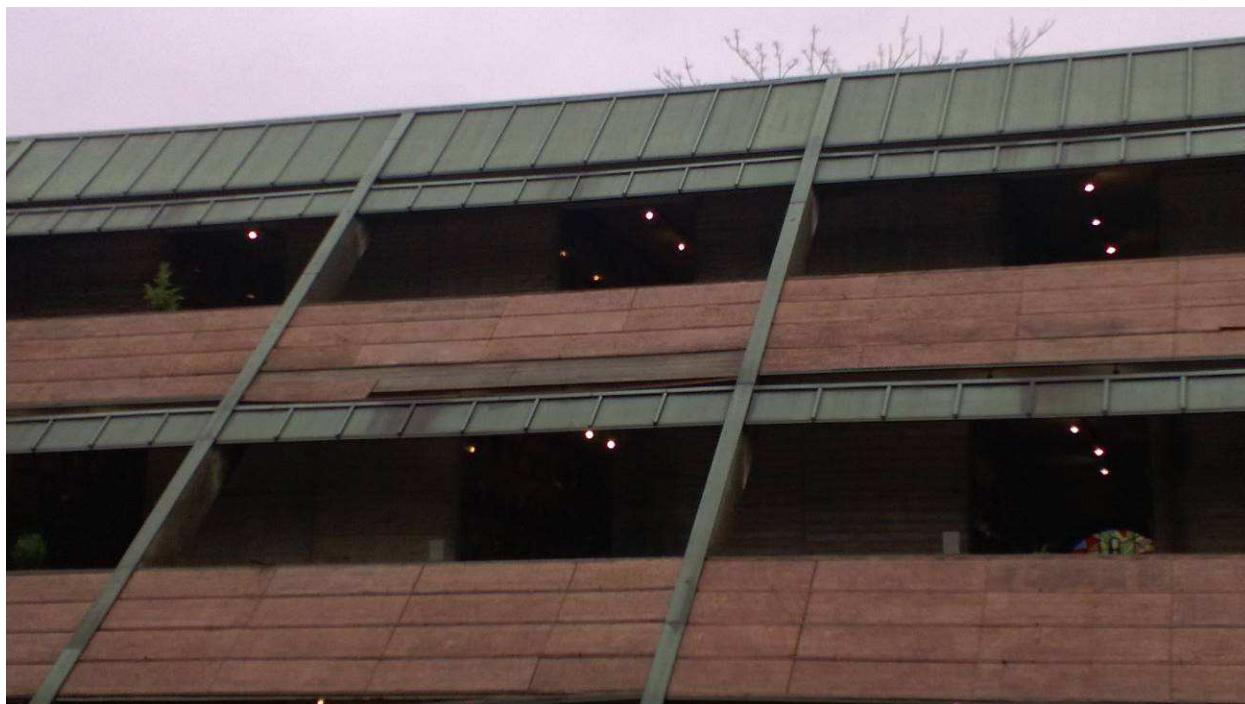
Prospetto colombari con lastre di rivestimento delle fioriere mancanti.
